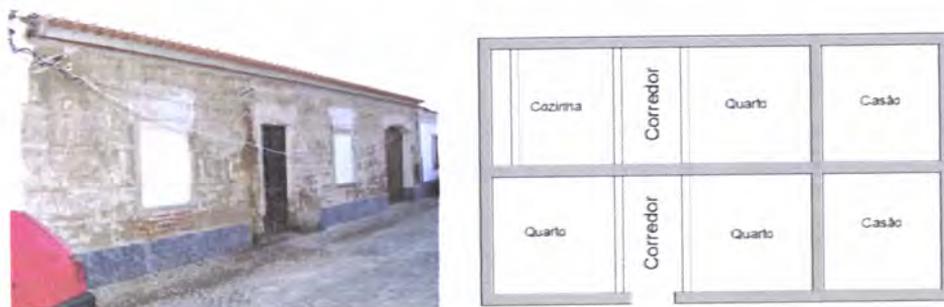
1 e 2; Rua de S. João, nº 3, casa com casão na fachada, casa Tipo 7 e planta esquemática
